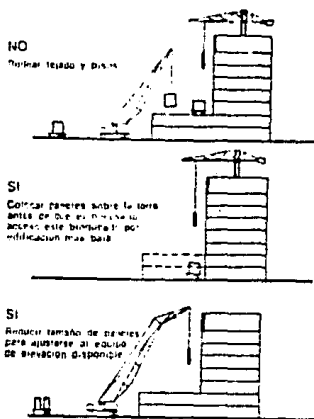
Acceso para remolques y equipos de elevación.
